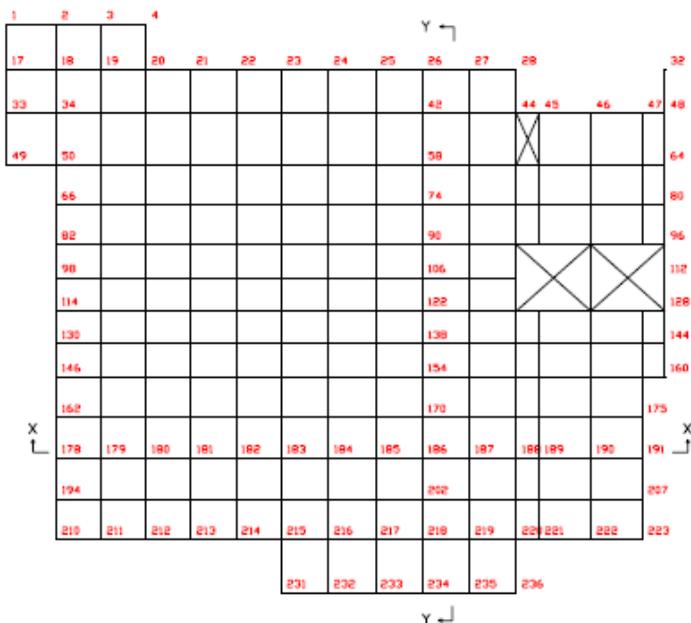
Discretização do pavimento tipo (Duarte, 1998)
